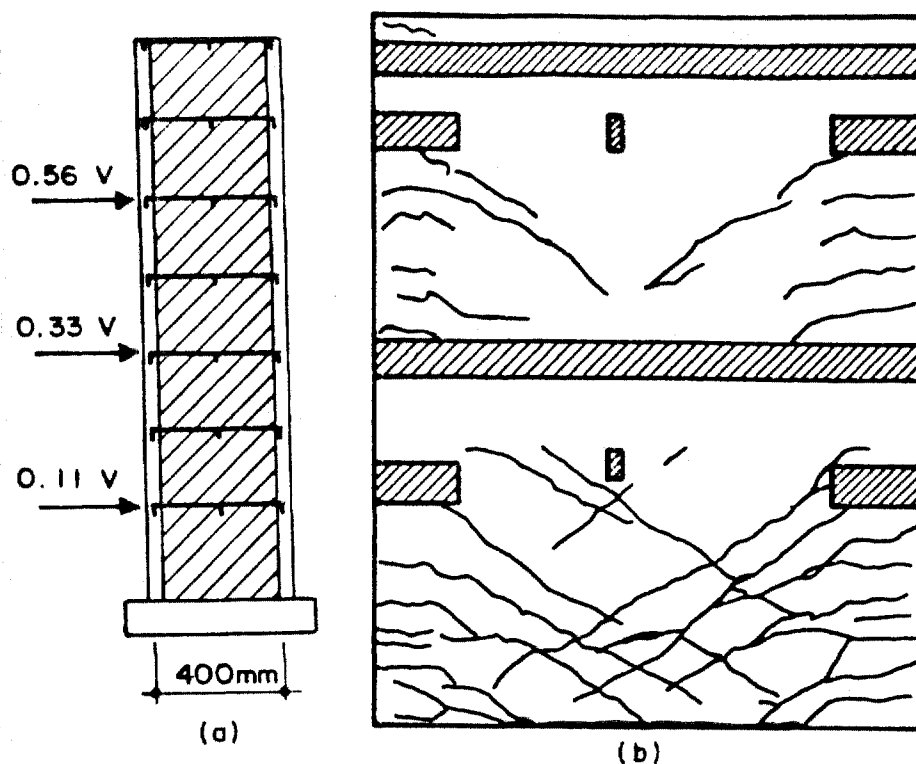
Fissuração típica em uma parede isolada
